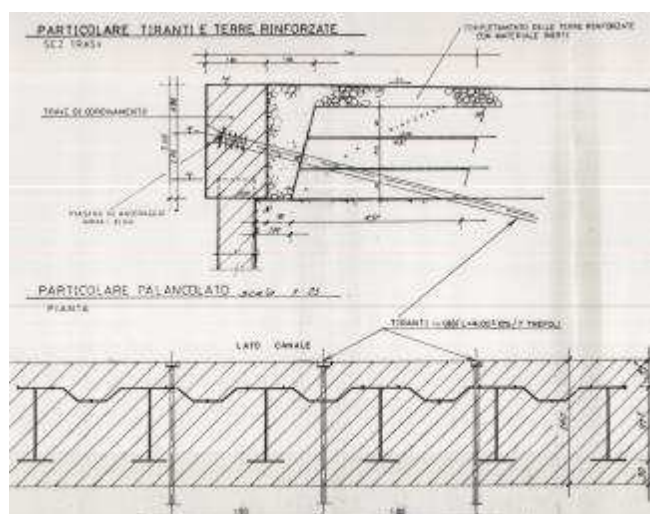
Stralcio planimetrico del banchinamento e particolare terre armate.
